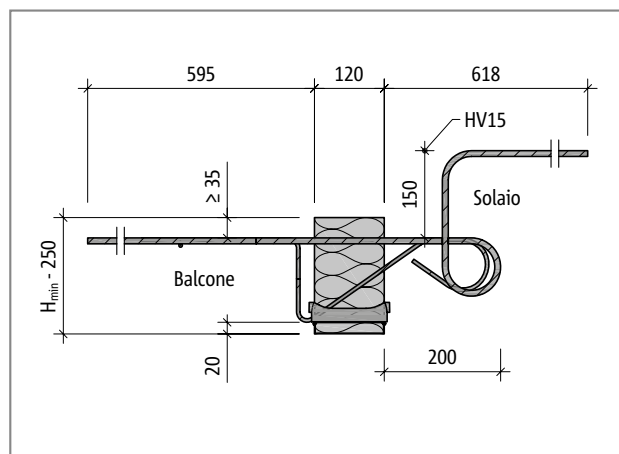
Schöck Isokorb® tipo KXT30-HV15: sezione dell'elemento
